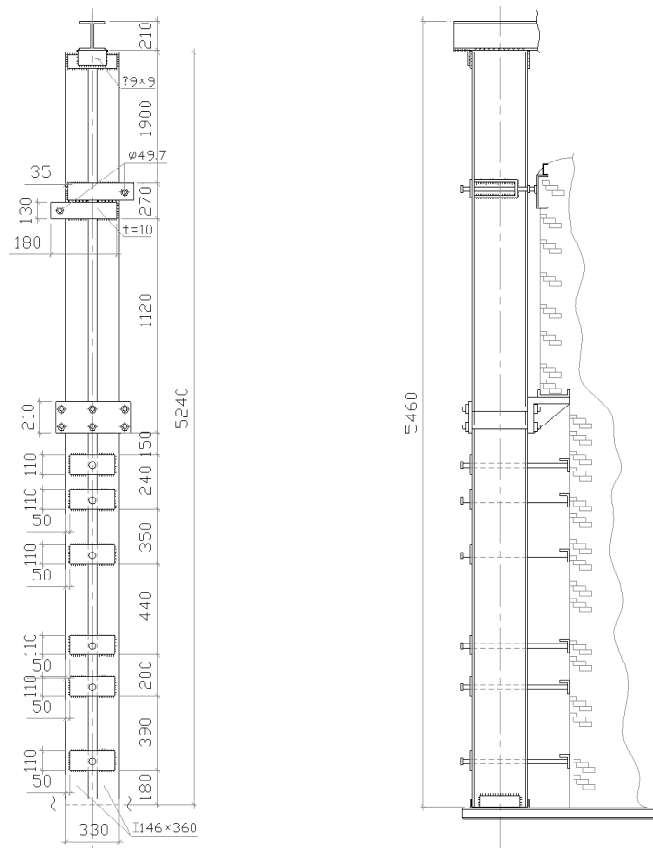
Конструкция колонны обвязки каркаса печи.
